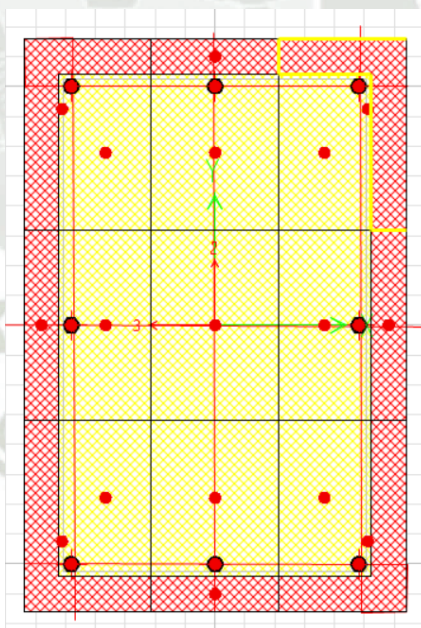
Sección transversal de un elemento seccionado por fibras
